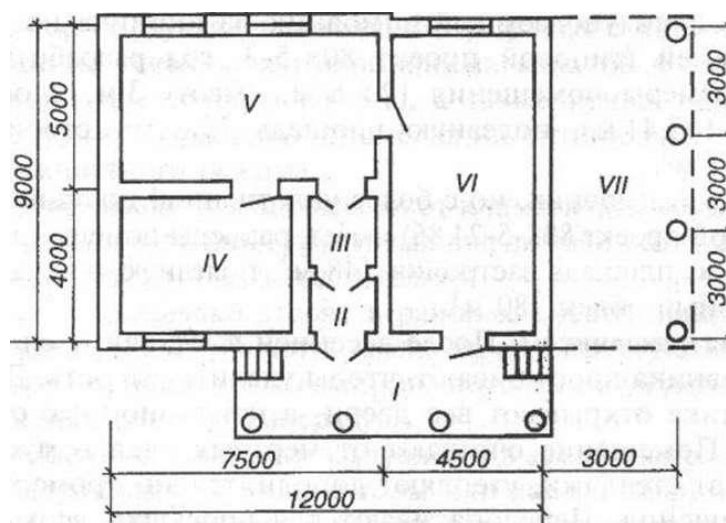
План пасечного дома для пчеловодческой фермы на 150 пчелиных семей:
